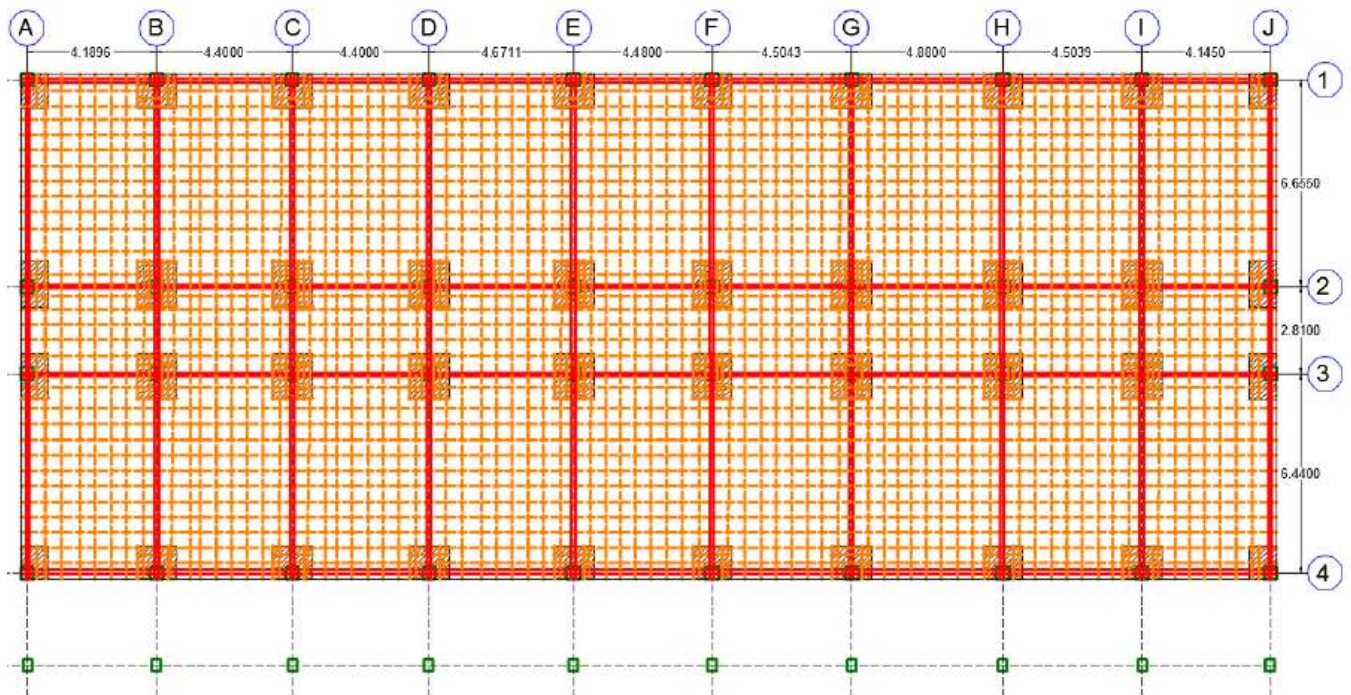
Planta de armado de losa plana. Fuente: (Loor, 2015)
